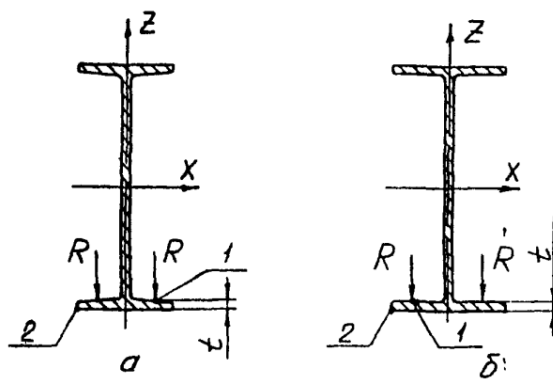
Схема сечений балки, представленных в СТО [3] а – с наклонными полками; б – с горизонтальными
